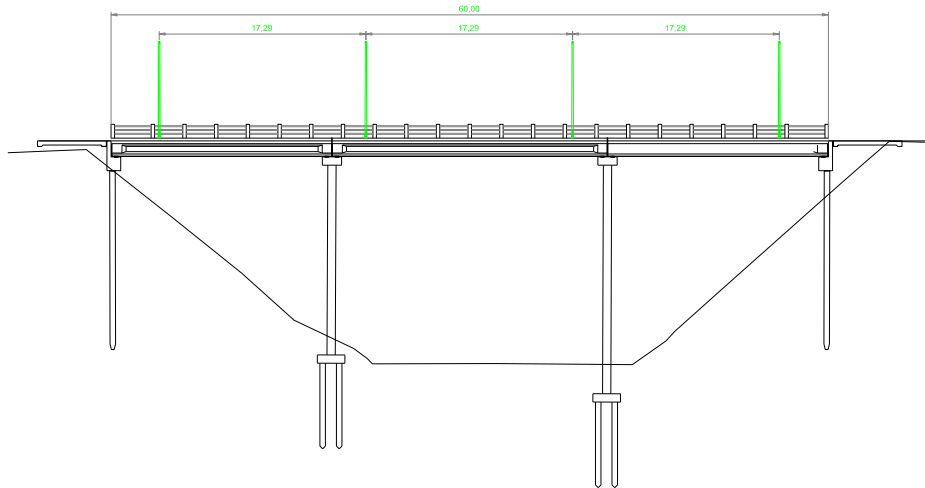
VISTA LONGITUDINAL DEL PUENTE
